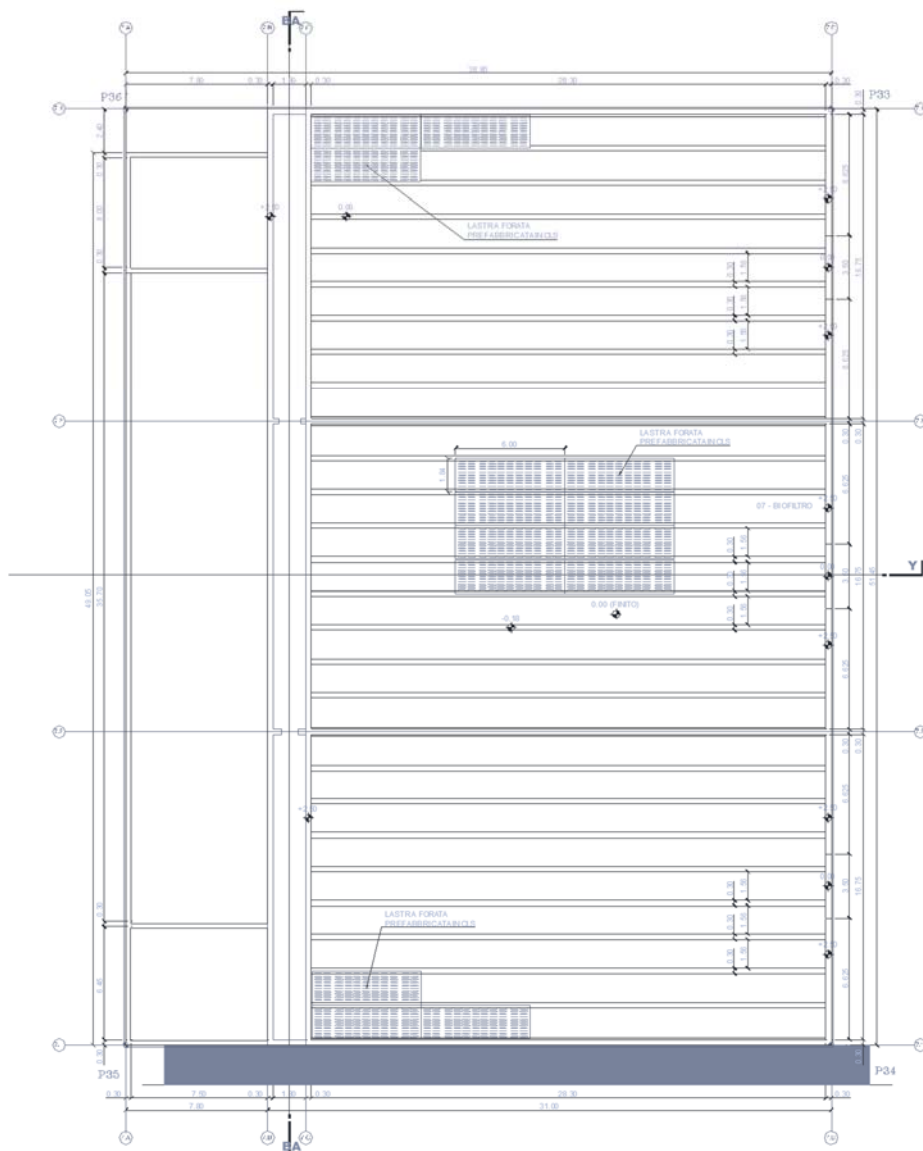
SEZIONE TRASVERSALE BIOFILTRO
